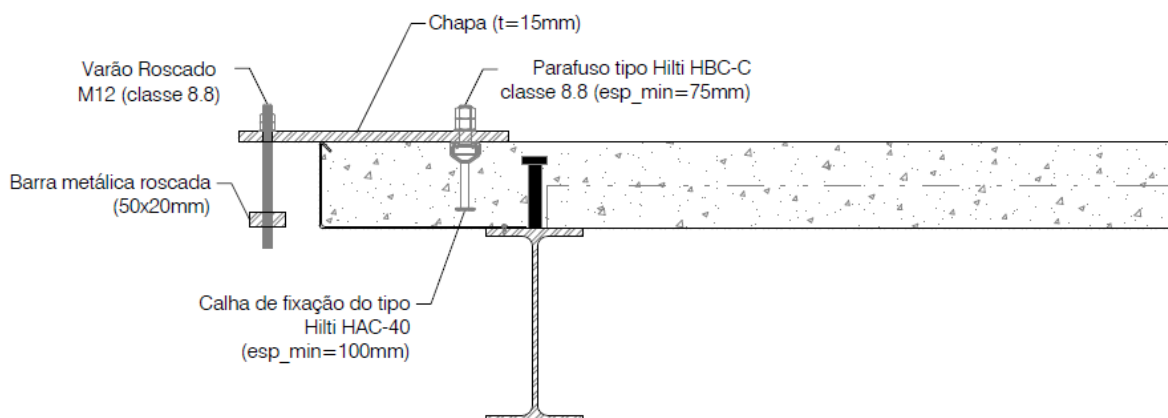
Esquema de montagem dos canais de ancoragem (ligação aço-betão da fachada).
